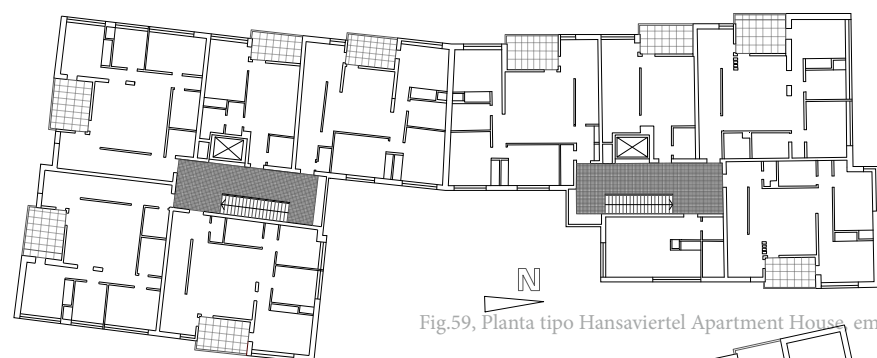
, Planta tipo Hansaviertel Apartment House, em Berlim, Alvar Aalto⁹⁷
